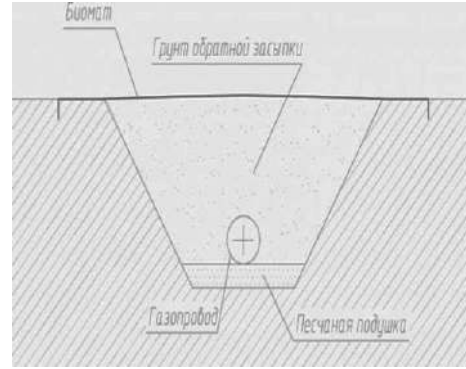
Защита грунтов обратной засыпки траншей газопроводов биоматами
